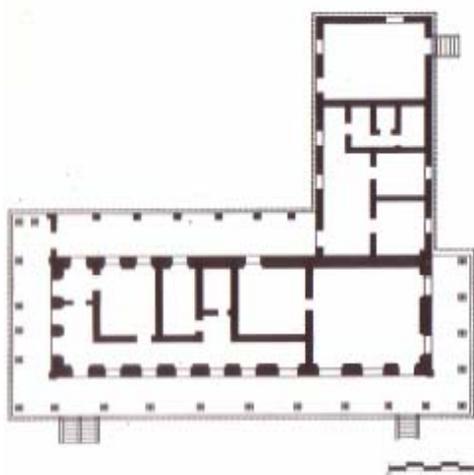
Planta Baixa da Casa Grande do Engenho Sete Rancho, em Amaraji – PE.
